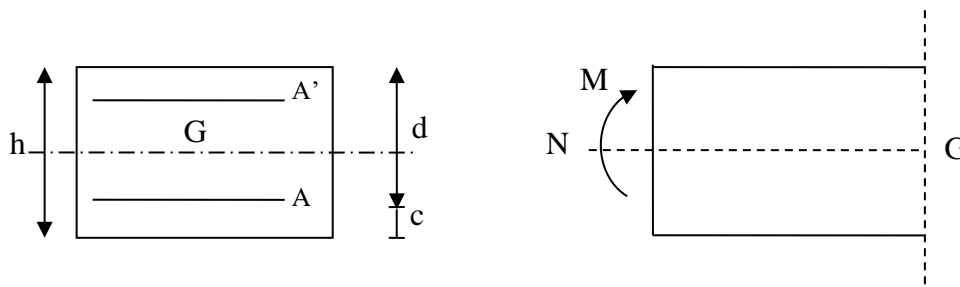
Schéma statique de calcul du ferrailage.
